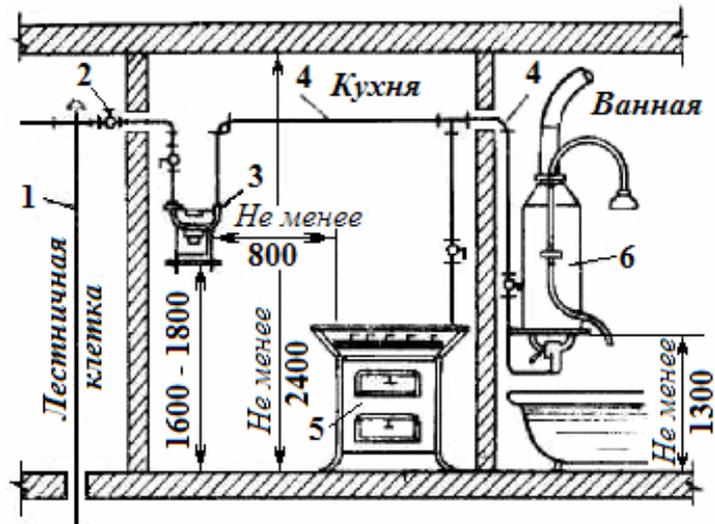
Схема сети газоснабжения жилого дома и внутридомового газового оборудования (ВДГО):
